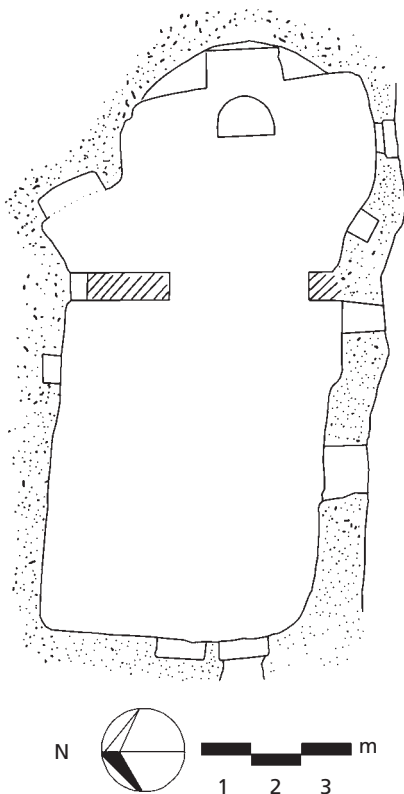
Deir al-Za'frān – Marienkloster, Klosterkirche, Grundriss. – (Nach Wießner, Christliche Kultbauten 1, Fig. 39).
